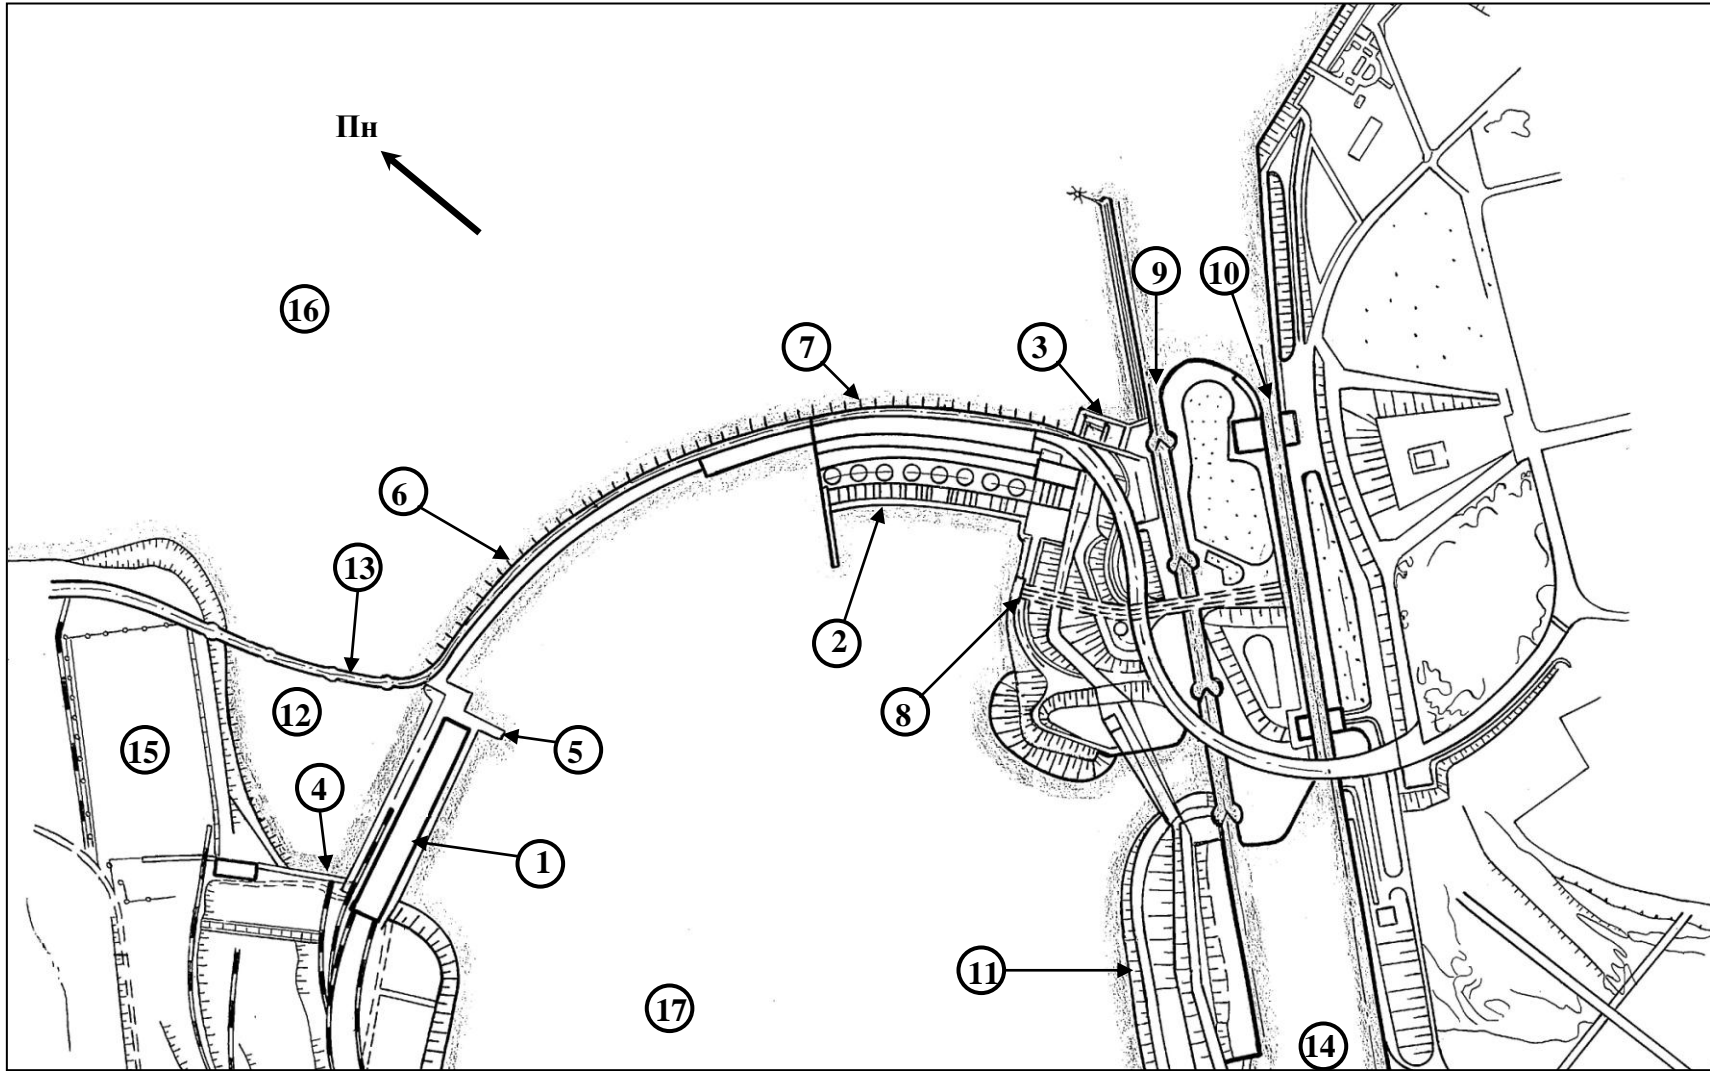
Фрагмент плану Дніпровського гідровузла: 1 – будівля гідроелектростанції 1; 2 – будівля гідроелектростанції 2; 3 – лівобережна глуха гребля; 4 – правобережна глуха гребля; 5 – стоян; 6 – водозливна гребля; 7 – щитова стінка гідроелектростанції 2; 8 – тунелі бічного водовипуску зі шлюзу; 9 – трикамерний шлюз; 10 – однокамерний шлюз; 11 – роздільна дамба; 12 – аванкамера; 13 – міст; 14 – низовий підхідний канал; 15 – відкритий розподільчий пристрій; 16 – Дніпровське водосховище; 17 – нижній б'єф
